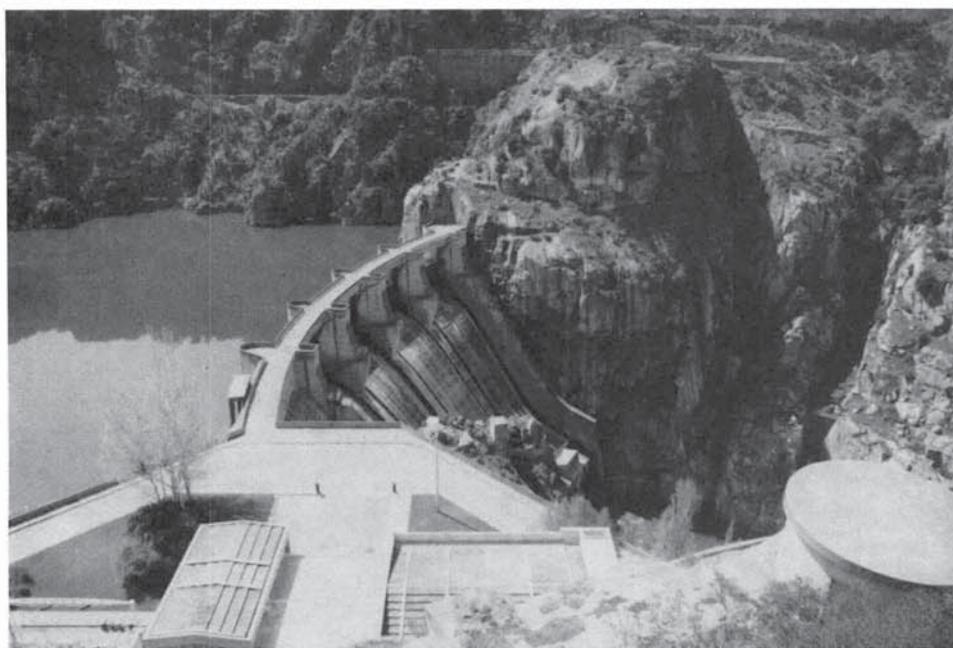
Presa de Picote vista hacia la orilla zamorana, se aprecian los restos de las obras existentes.
